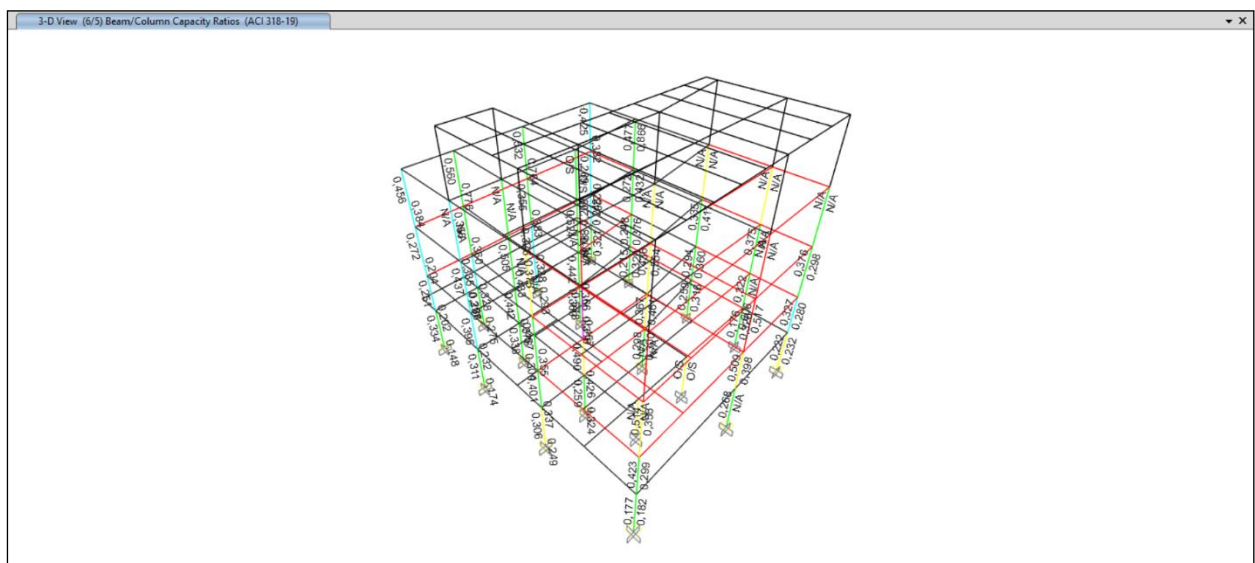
Relación 6/5 Viga-Columna de la edificación, alternativa 2 [Autor]
